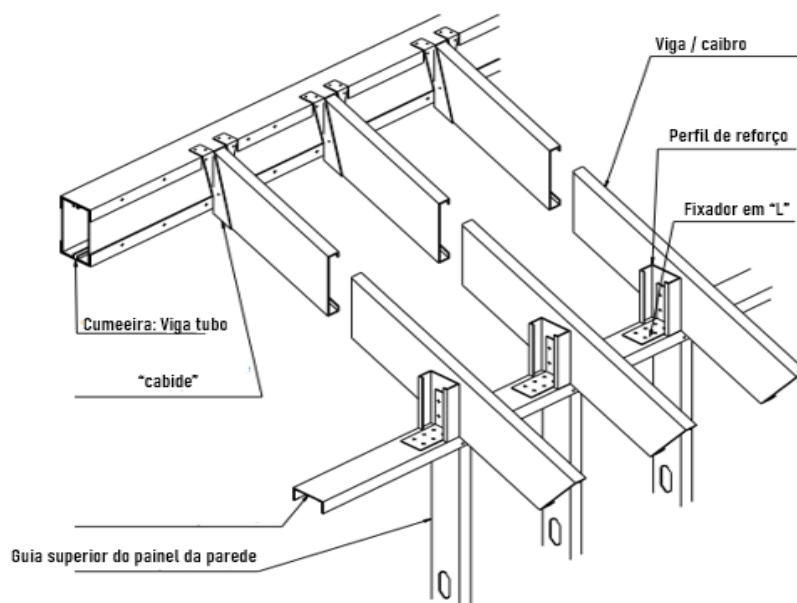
Pormenor cobertura inclinada, com vigas.
